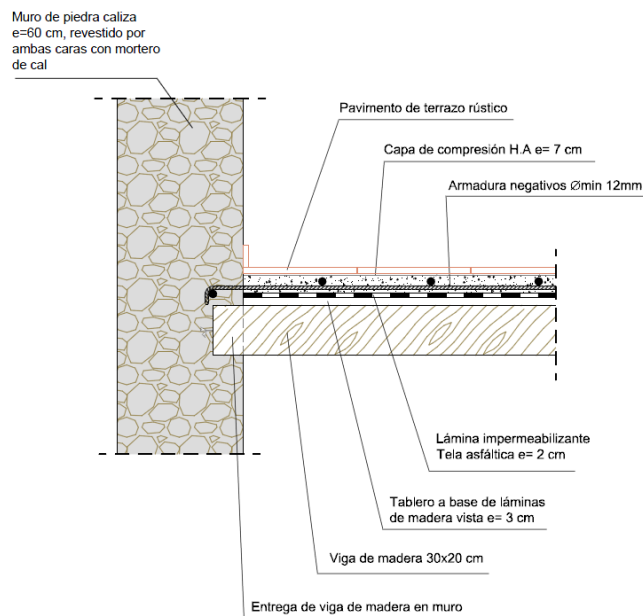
Detalle constructivo del forjado de planta primera. (Fuente propia)
